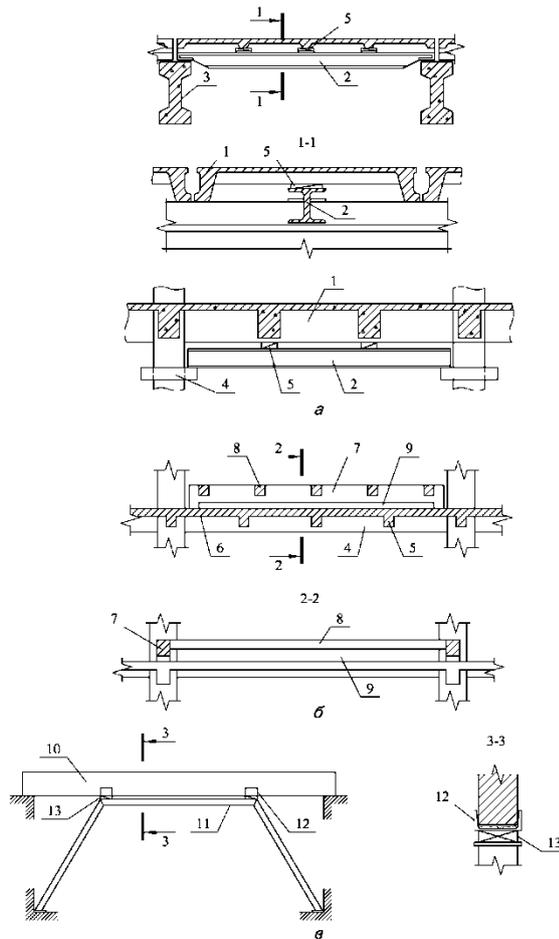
Схемы усиления железобетонных конструкций методом разгрузки и устройством дополнительных опор: а – подведением металлических разгружающих балок; б – полным разгрузением элементов монолитного перекрытия с передачей всей нагрузки на колонны; в – подведением разгружающих порталных рам; 1 – усиливаемые плиты; 2 – металлические балки усиления; 3 – металлические пластины– клинья для включения балок усиления в работу; 4 – главная балка существующего перекрытия; 5 – второстепенная балка; 6 – плита существующего перекрытия; 7 – главные разгрузочные балки; 8 – второстепенные разгрузочные балки; 9 – зазор между разгружающими балками и перекрытием; 10 – усиливаемая балка; 11 – дополнительные опоры в виде порталной рамы; 12 – опорные элементы из швеллера; 13 – металлические клинья для включения порталной рамы в работу
